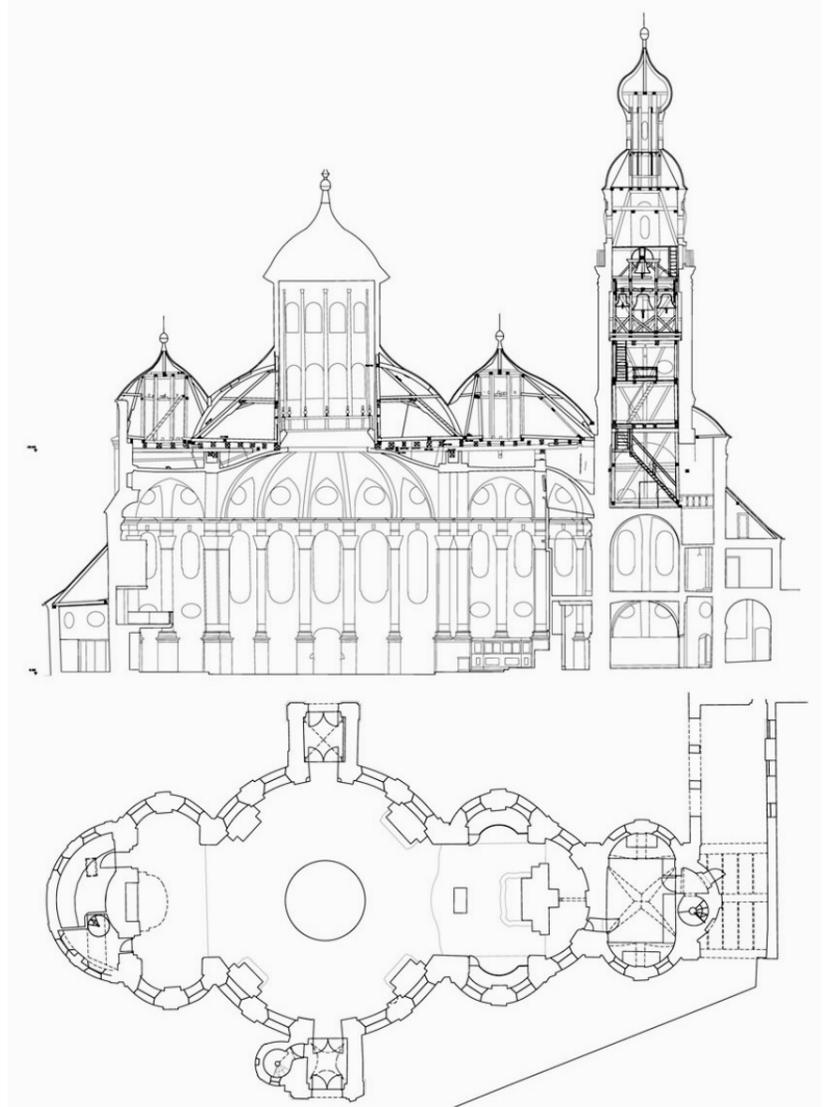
Grundriss und Schnitt o.M. Wallfahrtskirche Maria Birnbaum (Kayser + Böttges, vorm. Barthel +& Maus)
